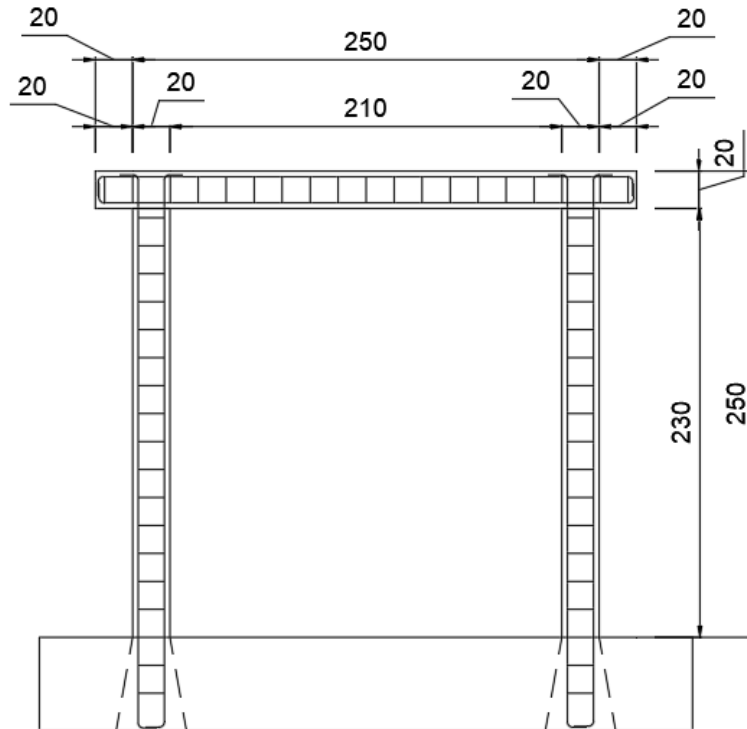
Armado general del muro de prueba (dimensiones en cm).
